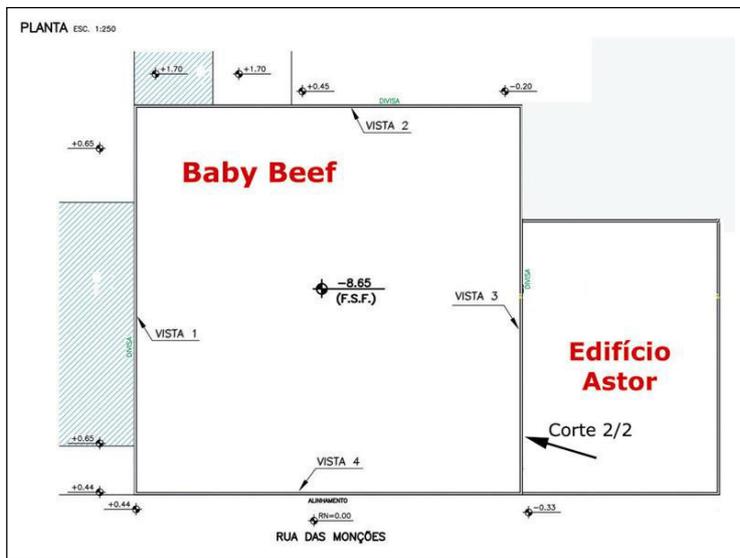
Planta do primeiro projeto geotécnico do Baby Beef.
